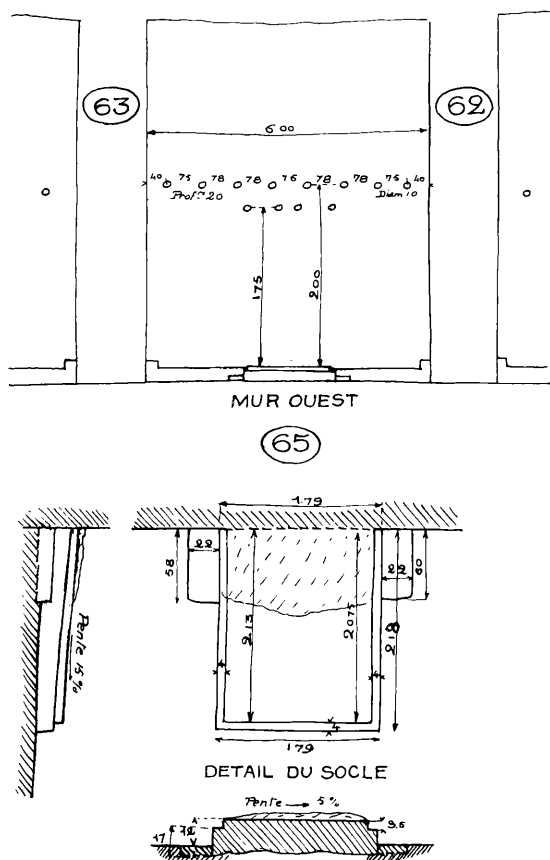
Salle 65. Détail du socle de pierre et élévation du mur ouest.
